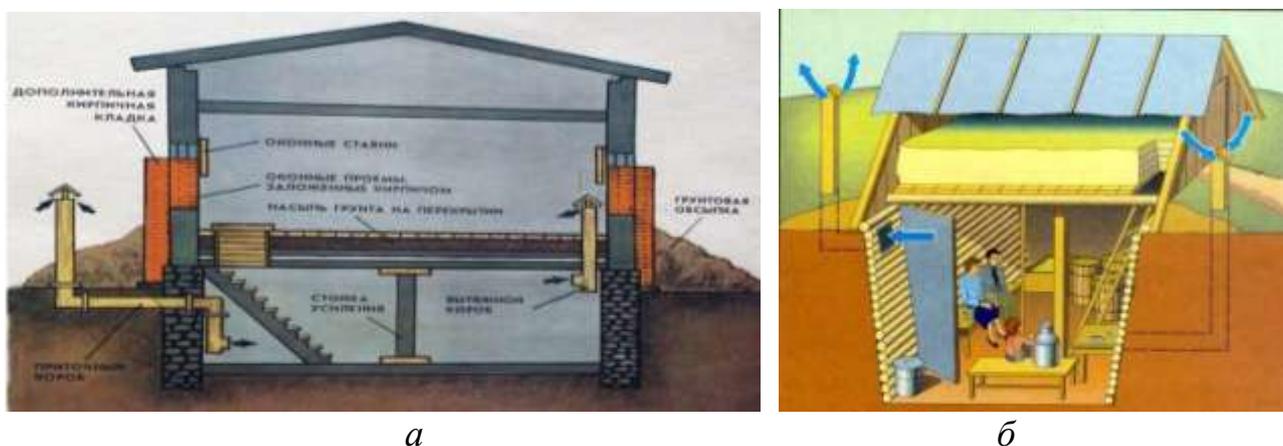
Оборудование подвального помещения (а) и погреба (б) под ПРУ
